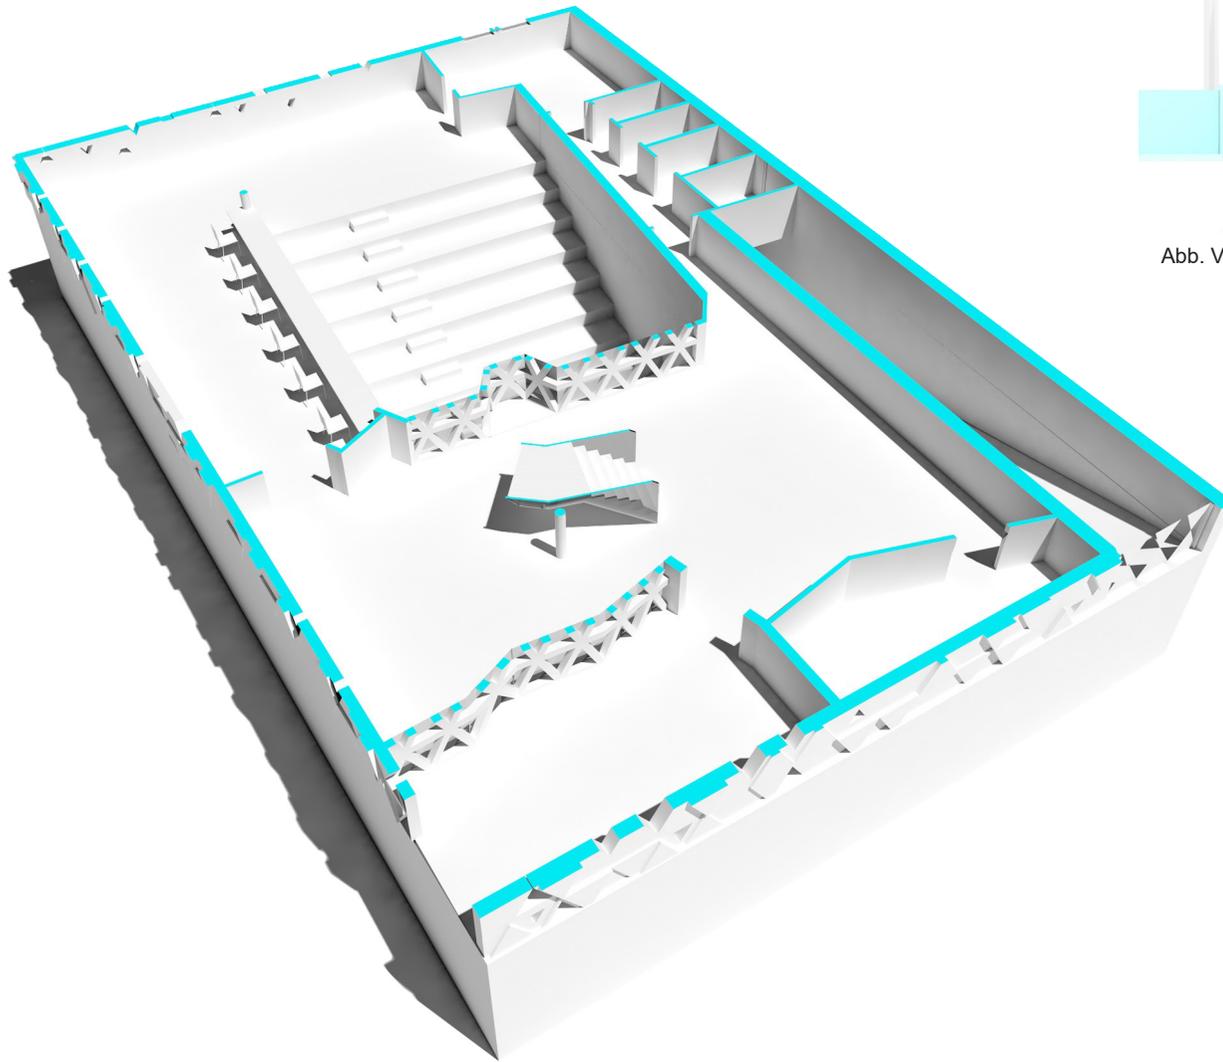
3D Darstellung Erdgeschoß
